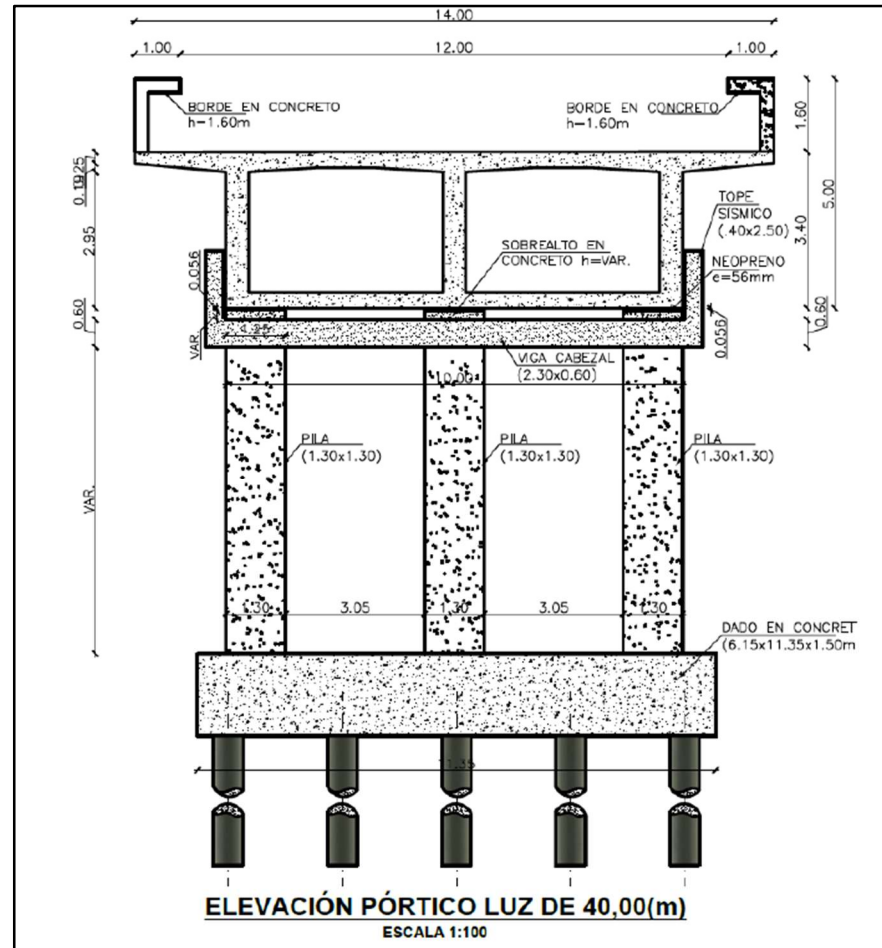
Sección Estructural tipo para viaducto con tres carriles y luz de 40 m
